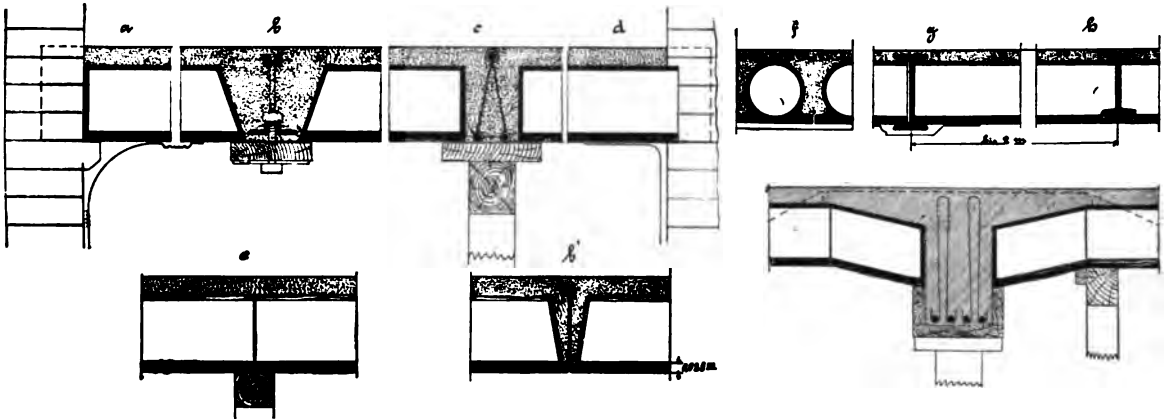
„Siegdecke“. Verschalung einer Decke mit Gipsformen. Verschiedene Verwendungsmöglichkeiten.
